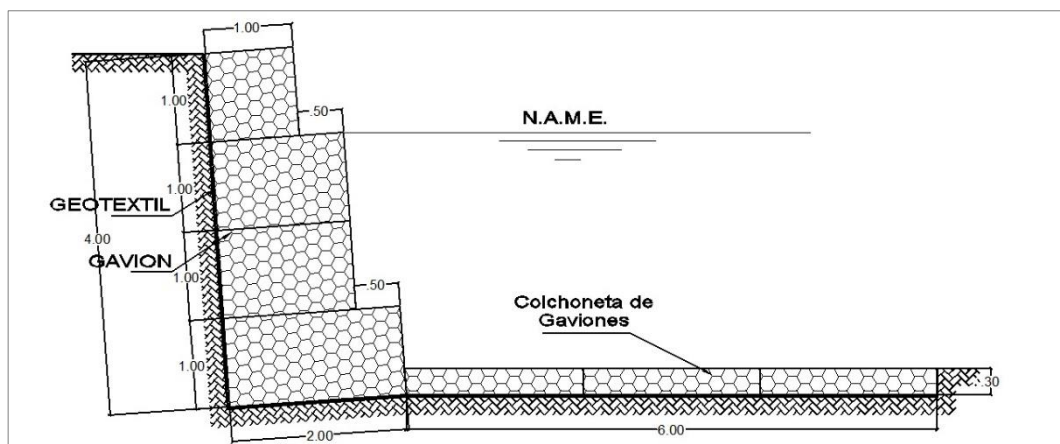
Sección propuesta de gavión, G-1C, h = 4.00 m y B = 2.00 m.
